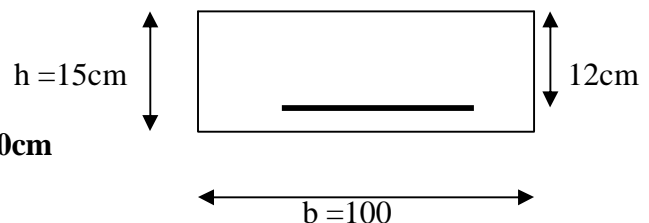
coupe vertical du plancher en dalle Pleine.
